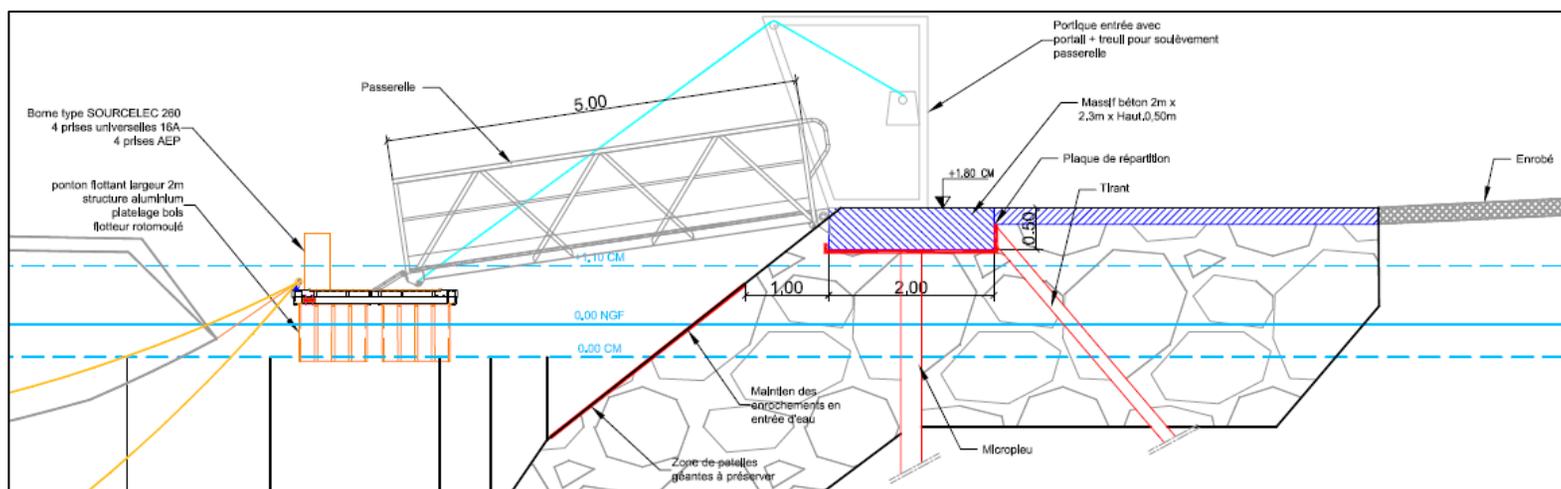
Coupe de principe sur massif béton passerelle Etat projet – ICTP 2020
